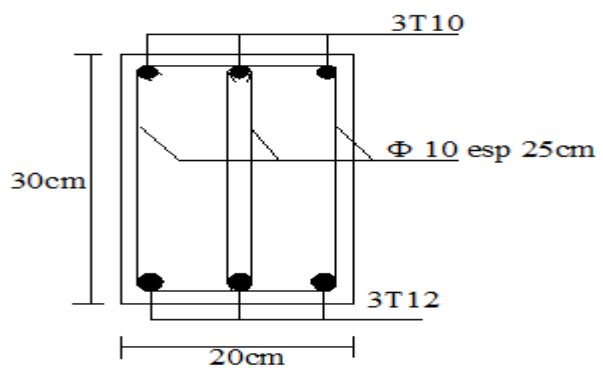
Schéma de ferraillage de la poutre palière.
